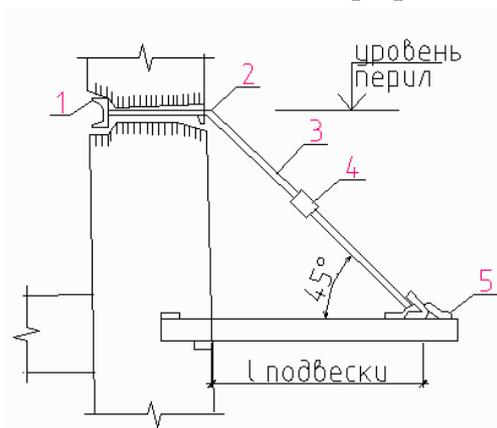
Усиление консольных балок подвеской: 1 – опорный швеллер; 2 – отрезок из круглой стали; 3 – тяж-подвеска диаметром 20 – 25 мм; 4 – натяжная муфта; 5 – скоба для подвески
